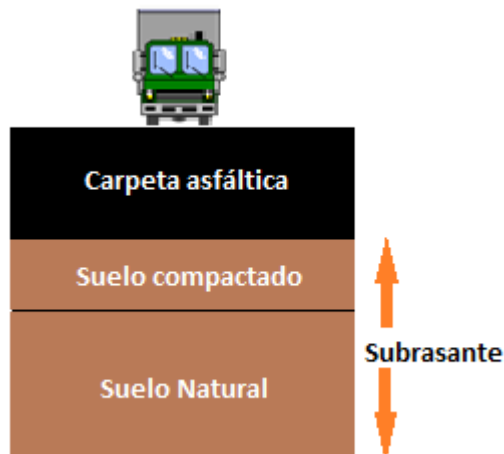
Estructura de pavimento de capa asfáltica gruesa.
